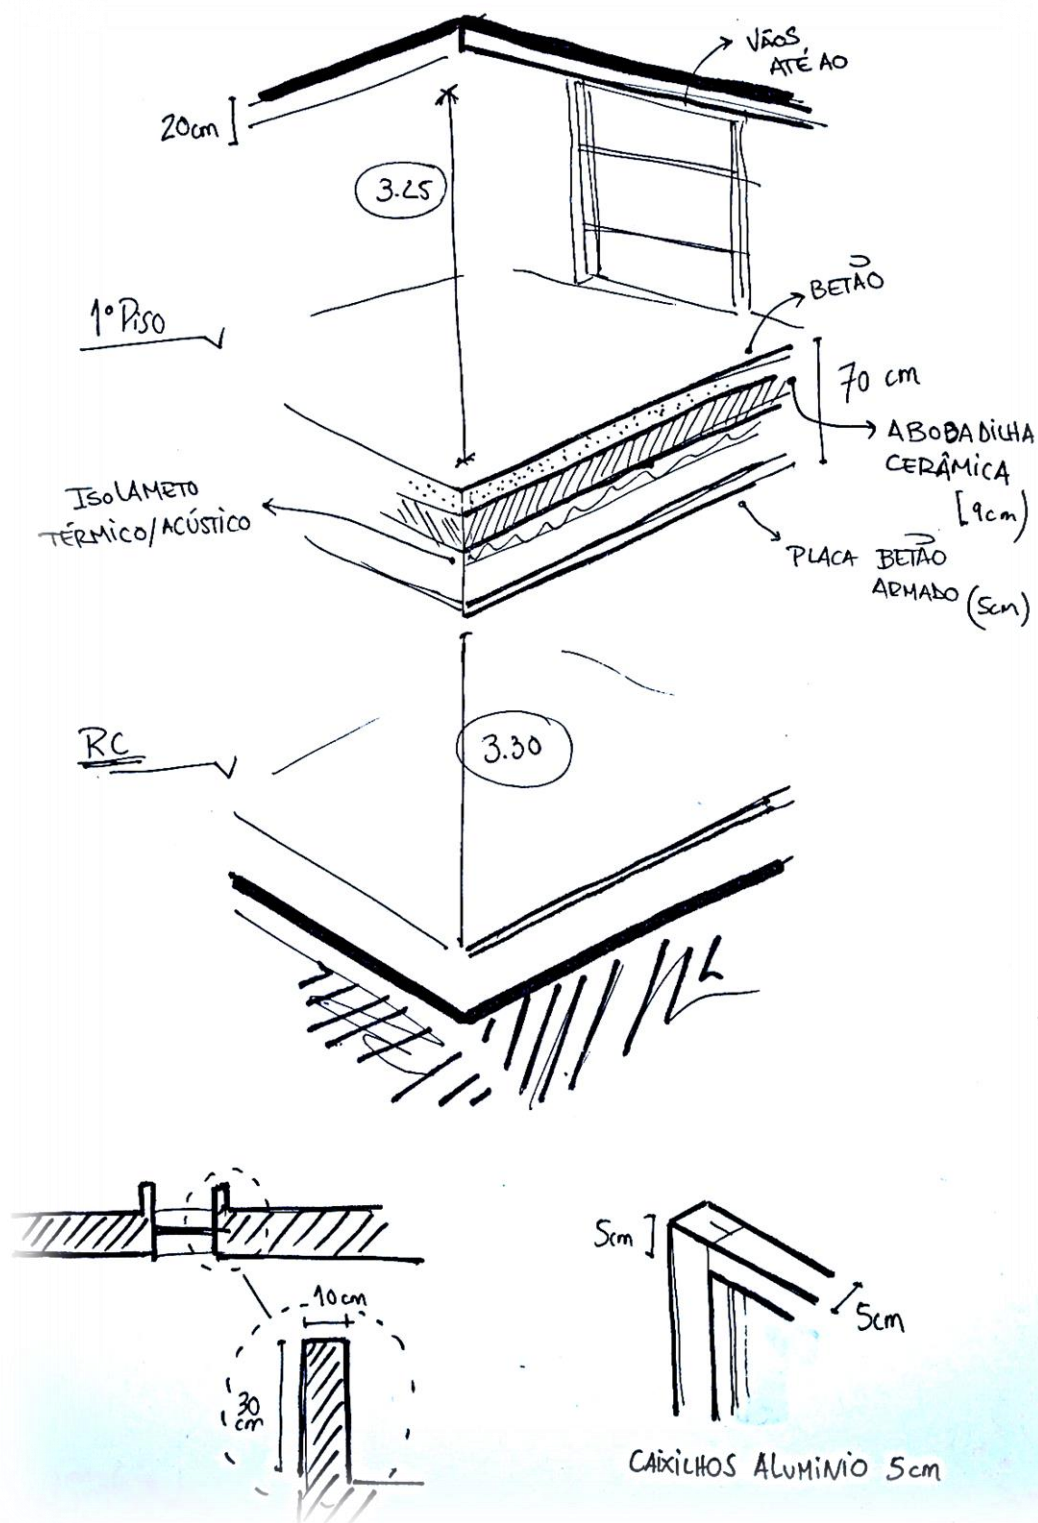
Esquízo de anotações do levantamento arquitetónico.
